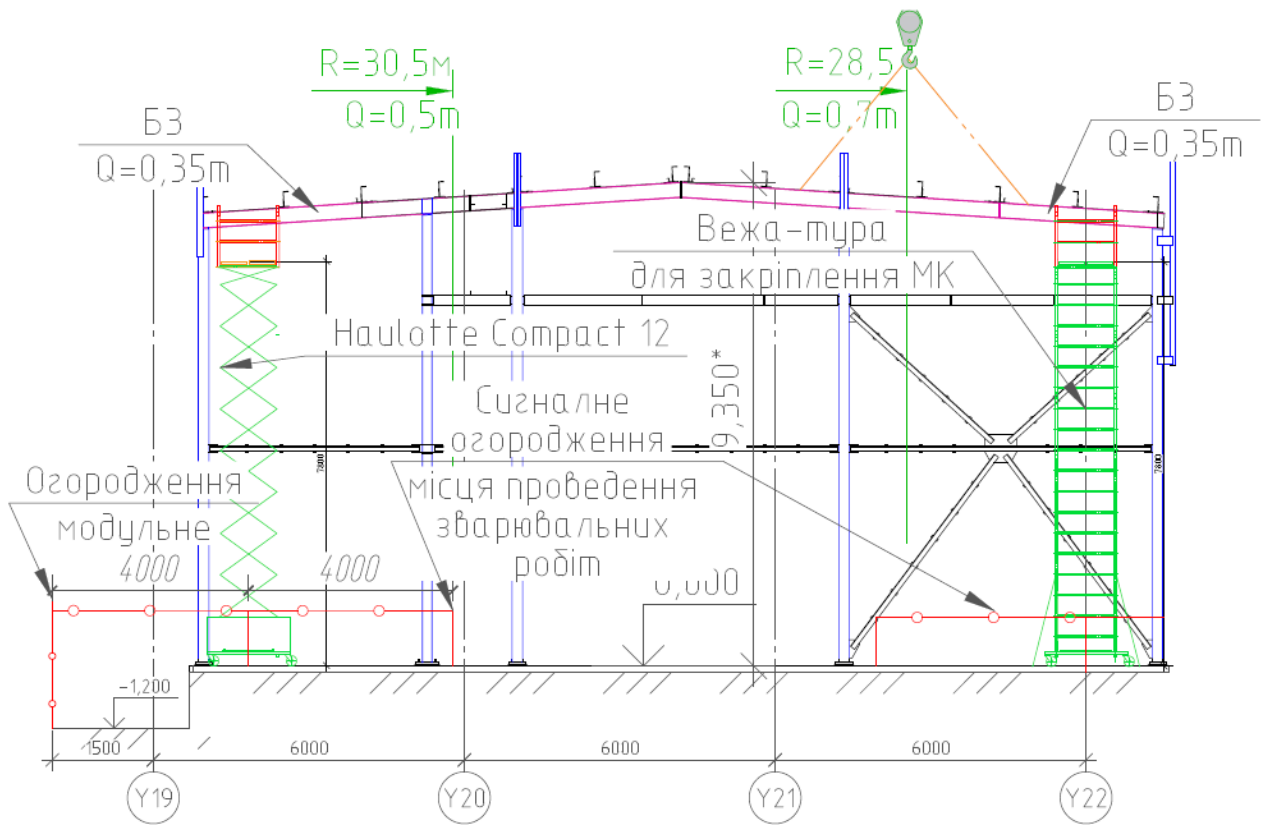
Схема монтажу балки БЗ в осях
